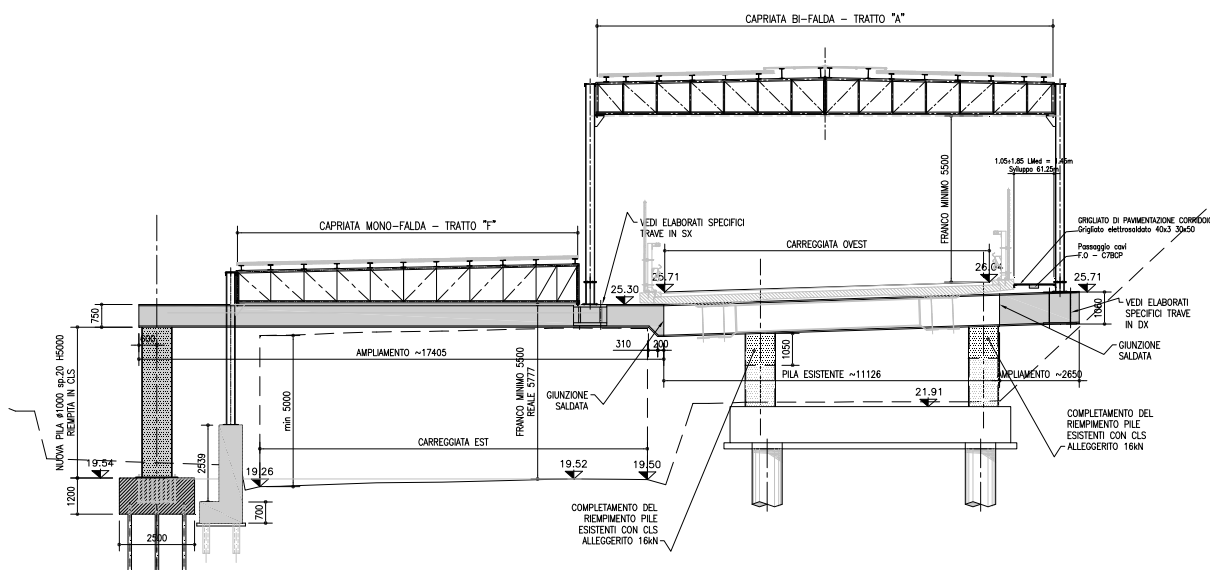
Sezione trasversale in corrispondenza della pila 9
